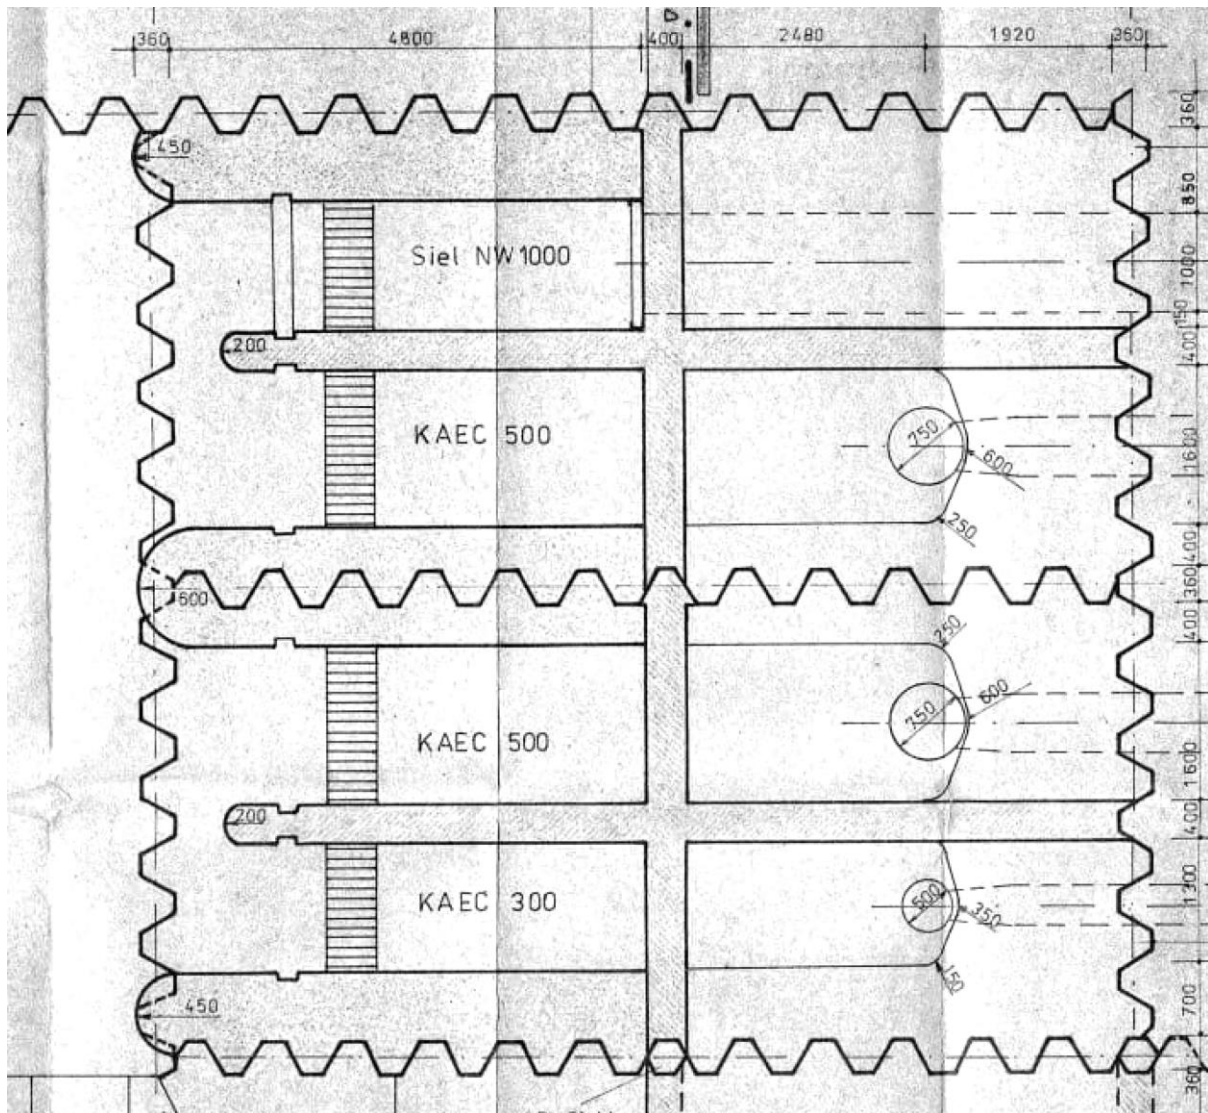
Schöpfwerk, Bestand, Grundriss Tiefbau
